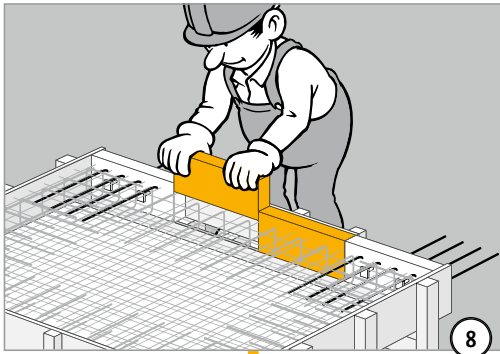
Inbouw Schöck Isokorf® type Q..E (speciale constructie met standaard Isokorf®).
